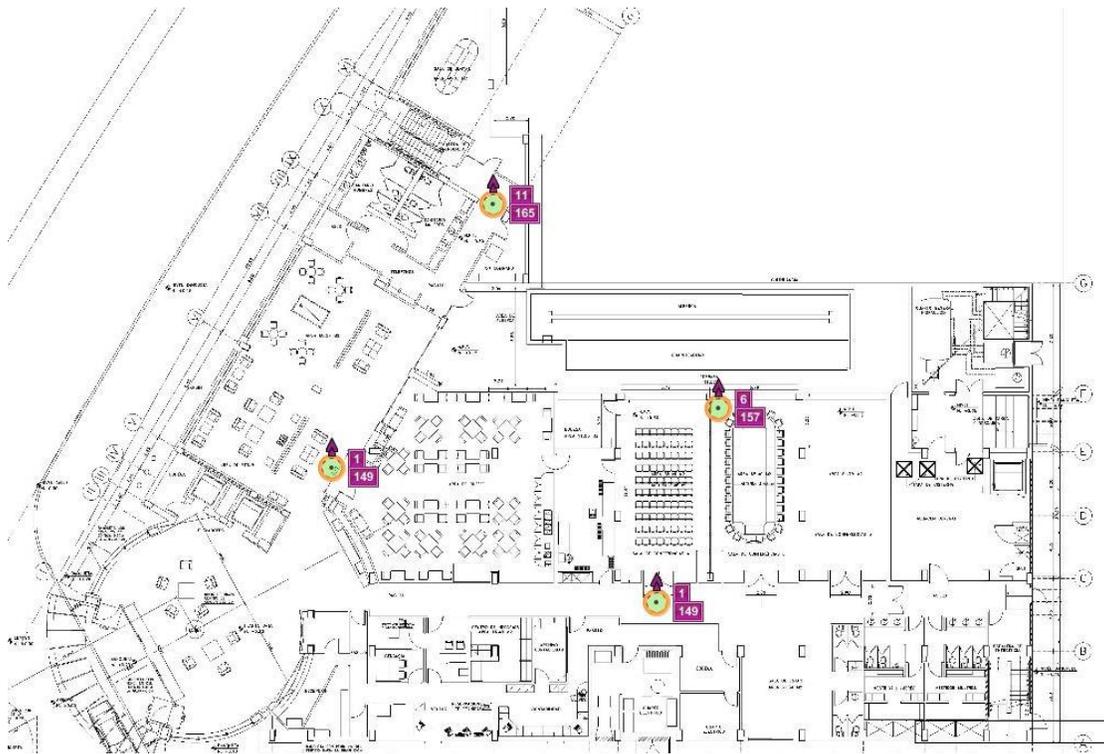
Ubicación preliminar de puntos de acceso en planta baja.
